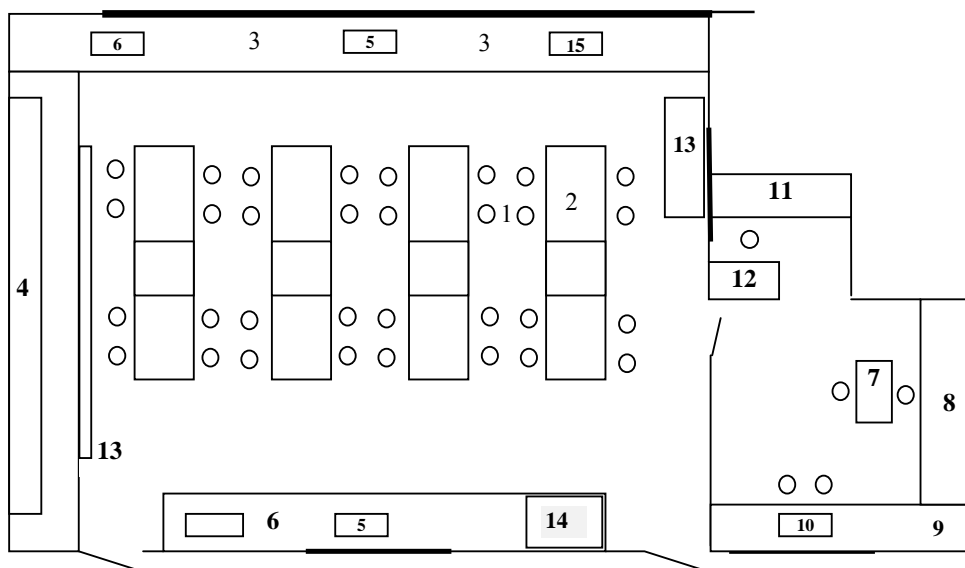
Denah tata ruang tetap laboratorium kimia
